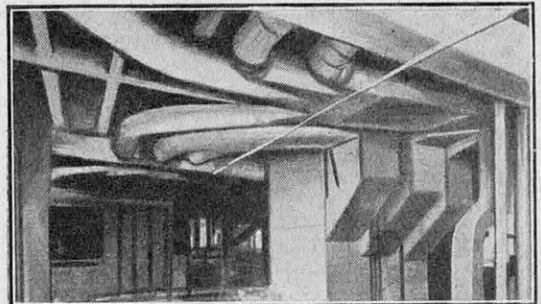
TROIS DES CONDUITES PRINCIPALES D'AIR DE L'UNION TRUST BUILDING
